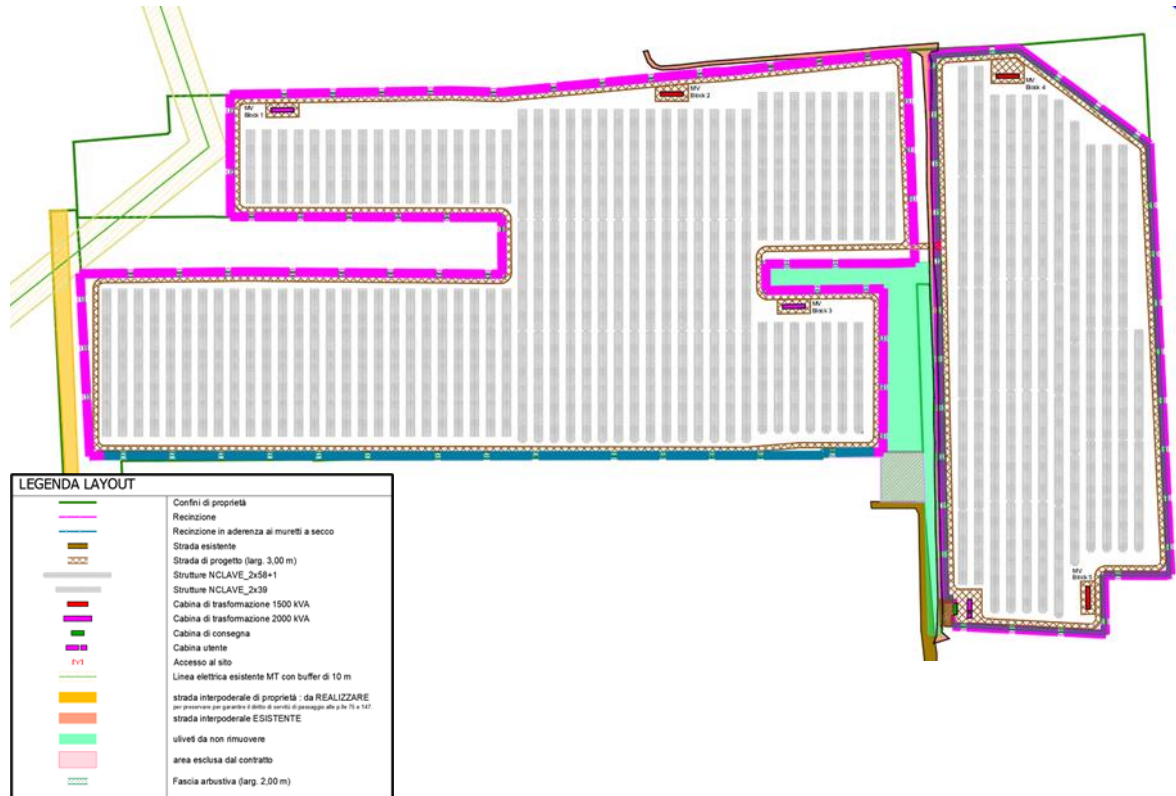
Area di impianto – In magenta le recinzioni aventi altezza pari a 2,65 m.
